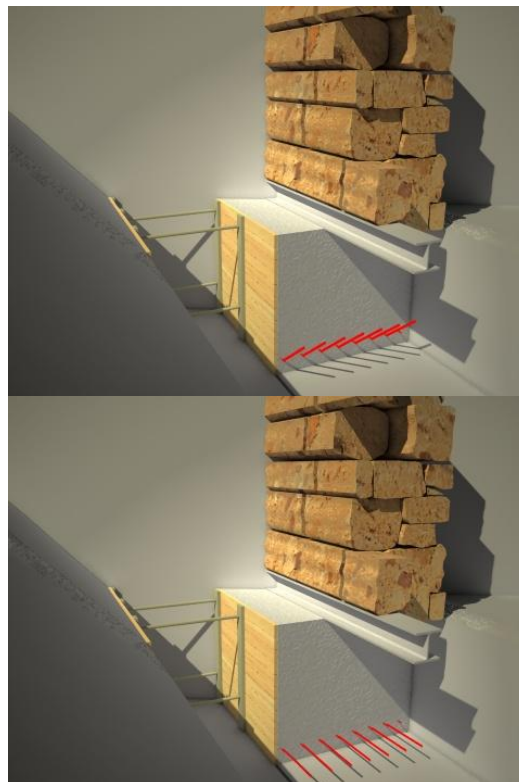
Detalle del desdoblado de las armaduras de enlace.
